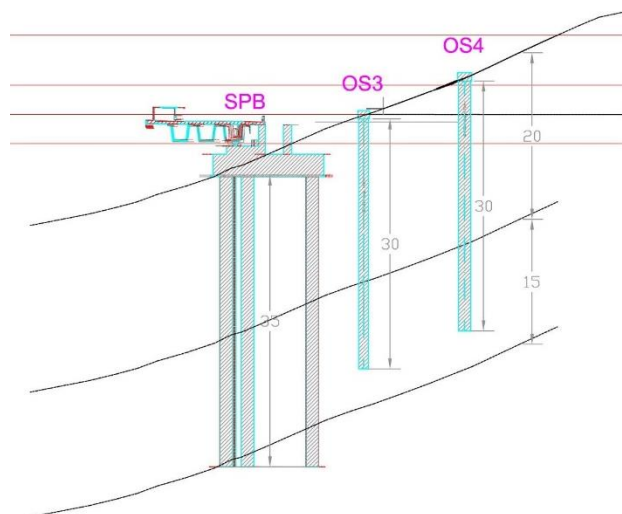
Geometria di riferimento OS-3 – OS-4 e Muro ad "U" (sezione 4-4).
